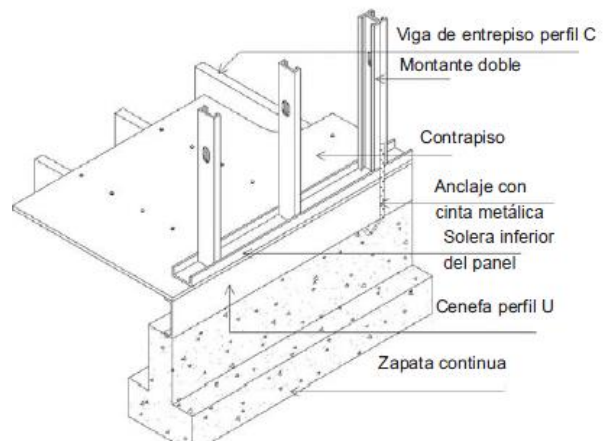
Cimentación tipo zapata corrida. (Sarmanho Freitas & Moraes de Crasto, 2007).
